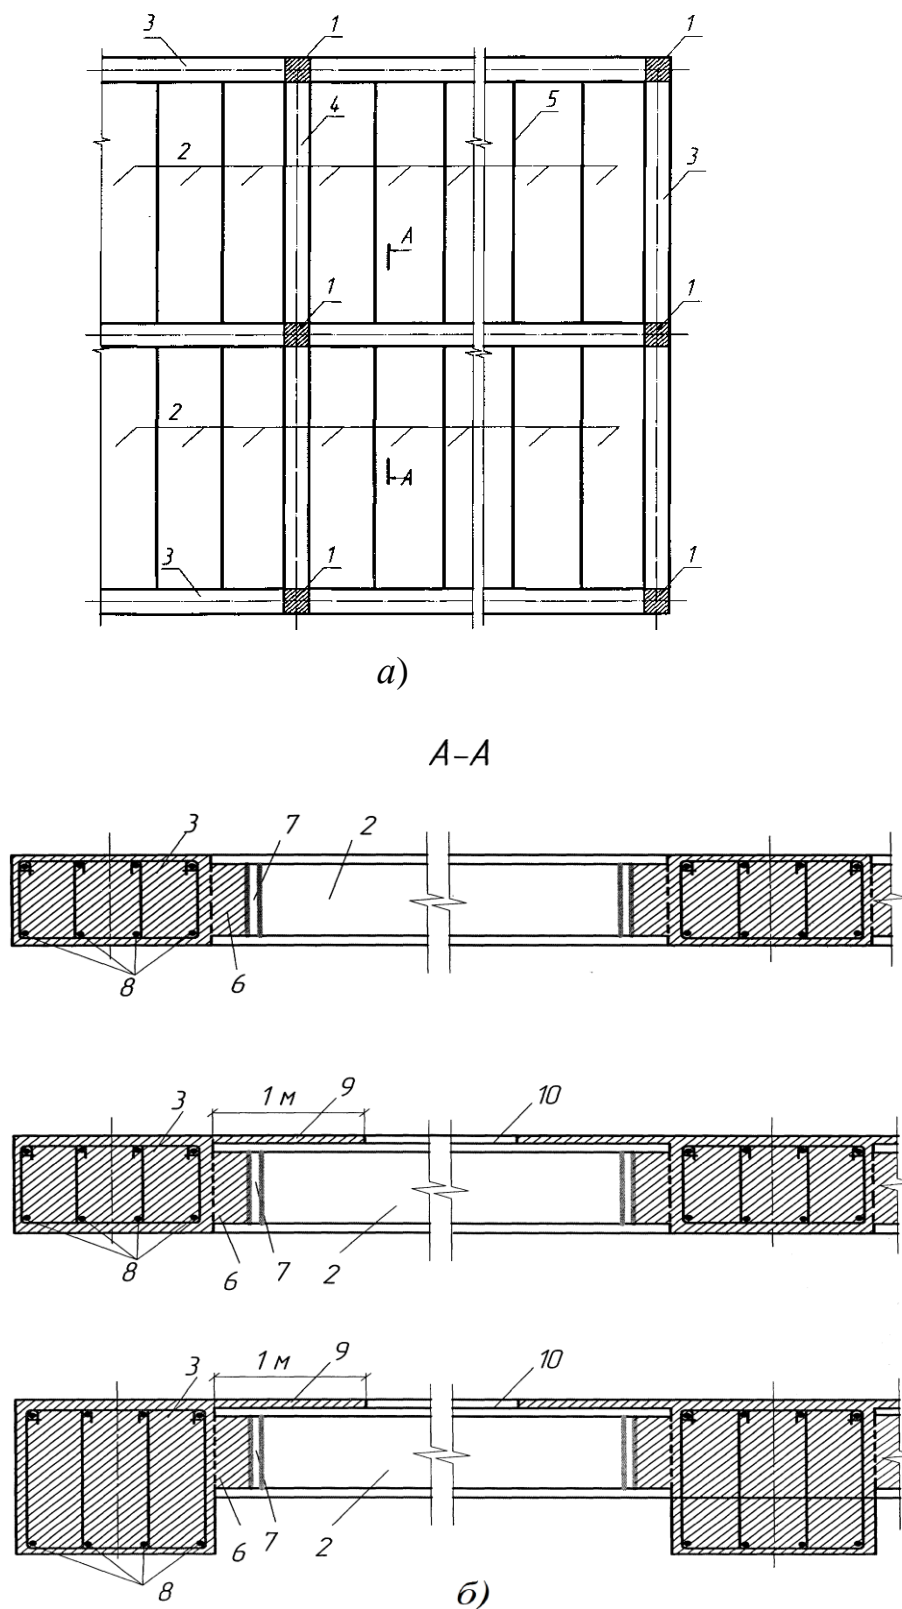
Конструкція перекриття та варіанти поперечних перерізів несучих ригелів у прольотах між колонами:
